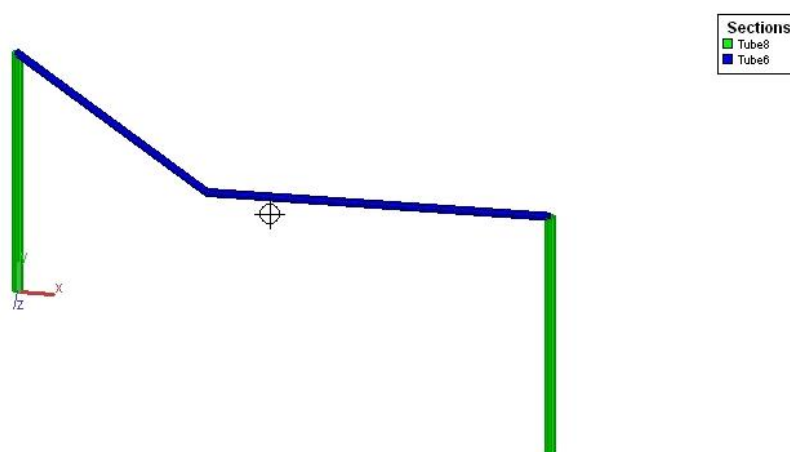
Solução 1 – Estrutura sem Apoios; Azul: Tubagem 6”; Verde: Tubagem 8”;
